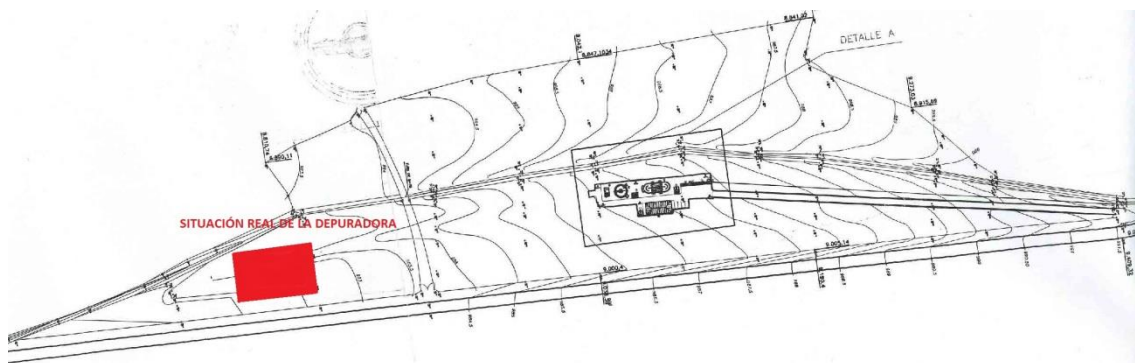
Plano comparativo de la situación de la EDAR en el proyecto Inicial y en la Ejecución Final
